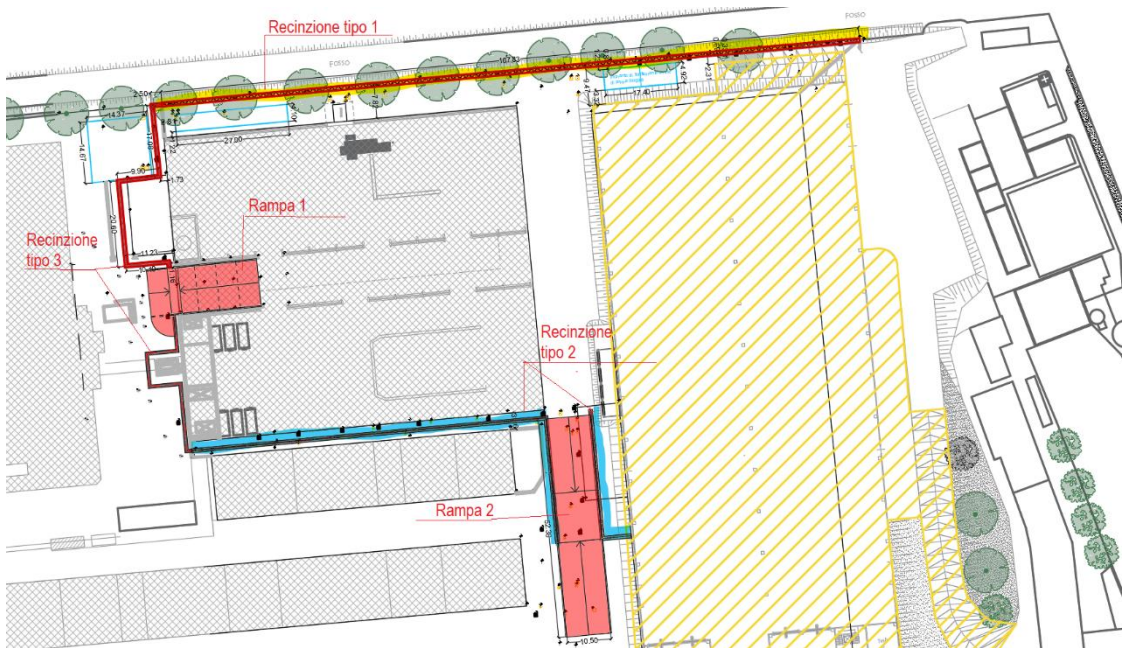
Estratto planimetrico con indicazione dei tratti di recinzione per la messa in sicurezza idraulica.
